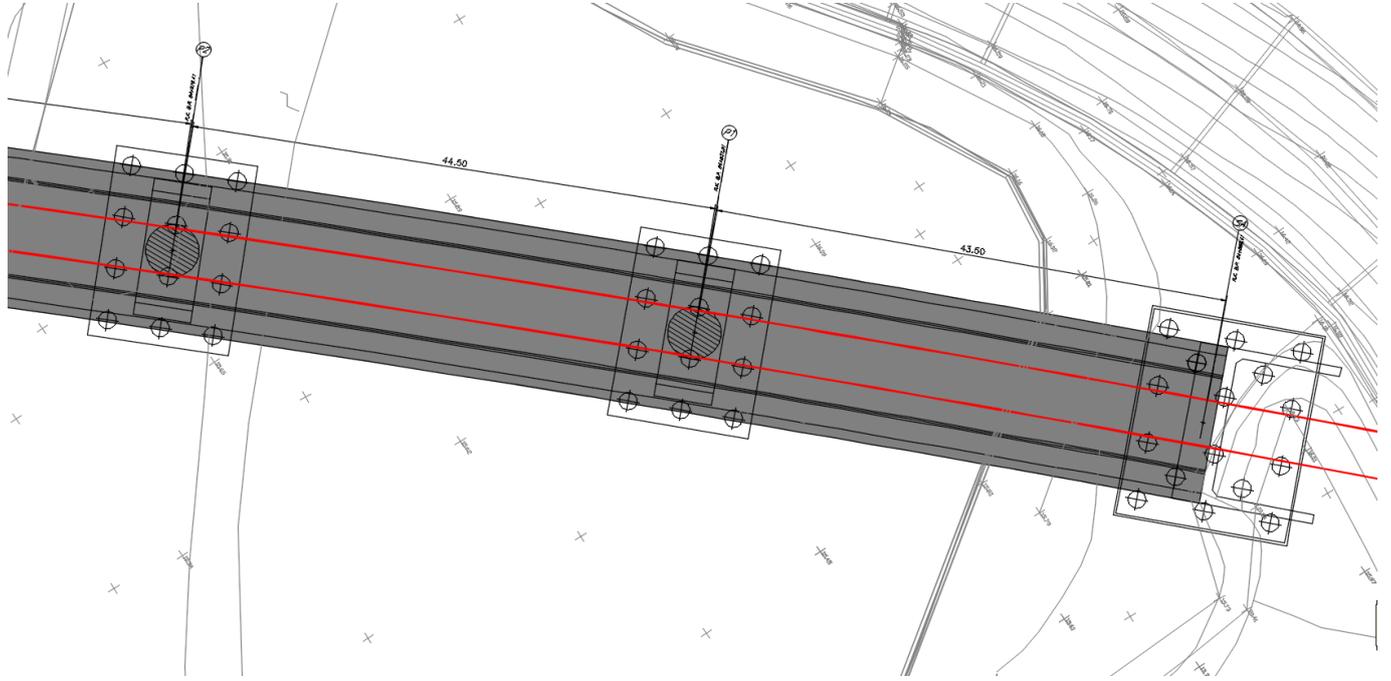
planimetria generale tra Pila2 e Spalla A
